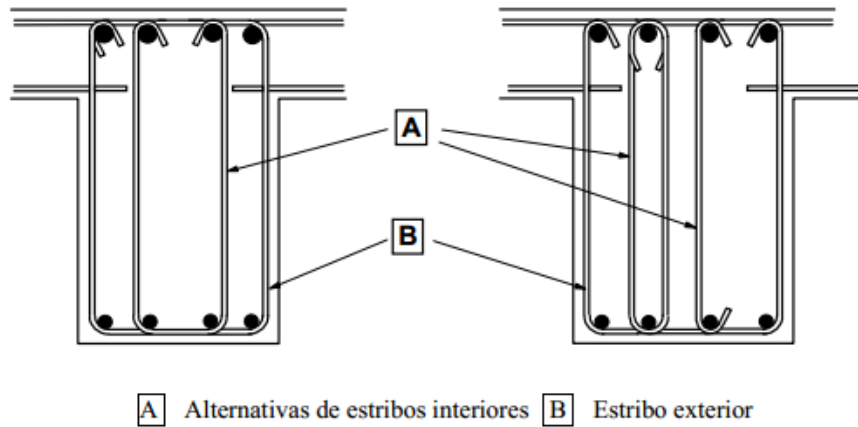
Exemplos de armaduras de esforço transverso (Figura 9.5 do EC2)
